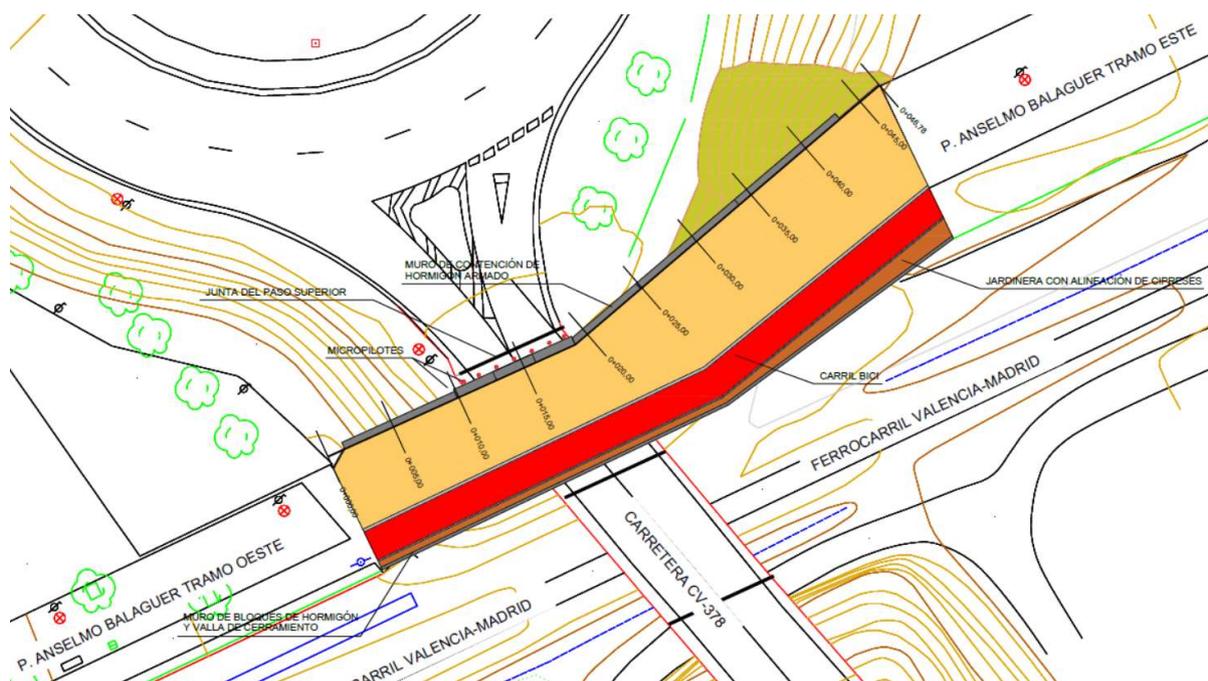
Planta general de la solución alternativa. Fuente: propia
